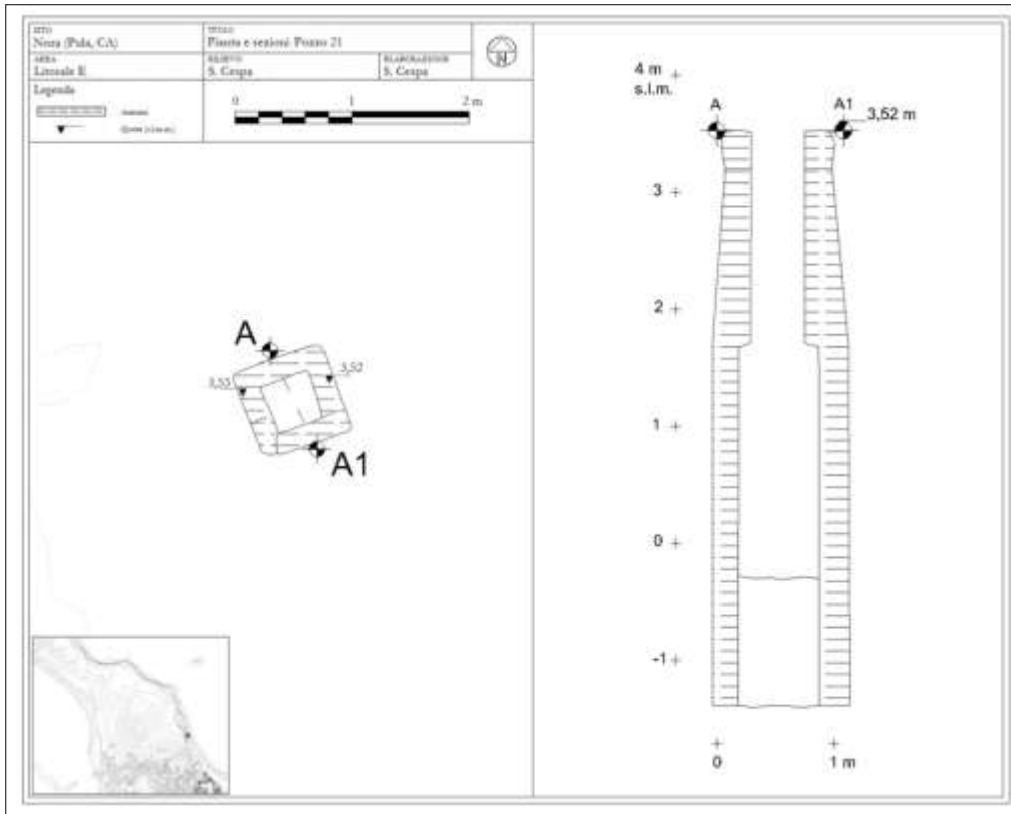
Pianta e sezione del pozzo 21 (elaborazione dell'autore).
